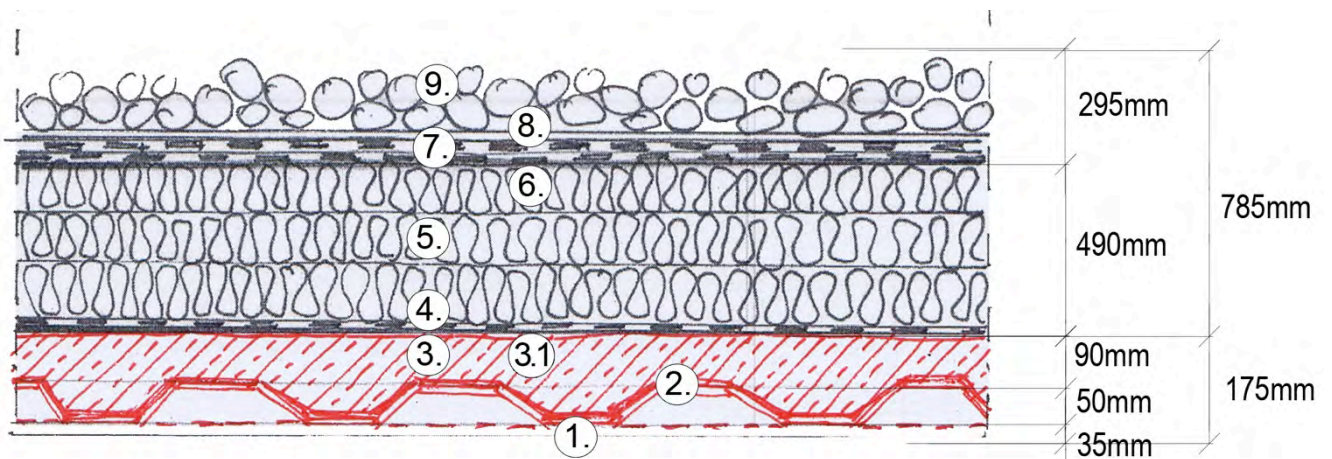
Bauteil, Dachbeläge, Decke Trapezblech
